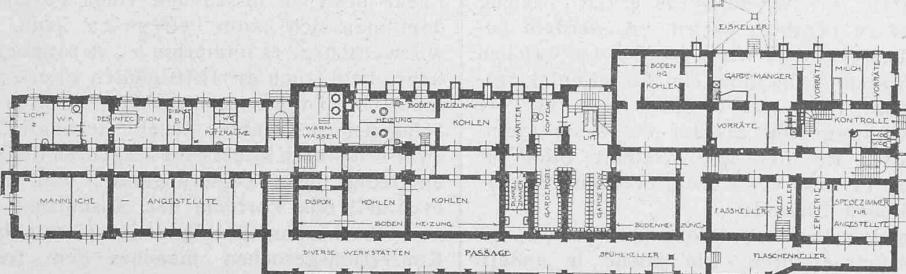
Grundriss vom Kellergeschoß. — Maßstab 1:750.
